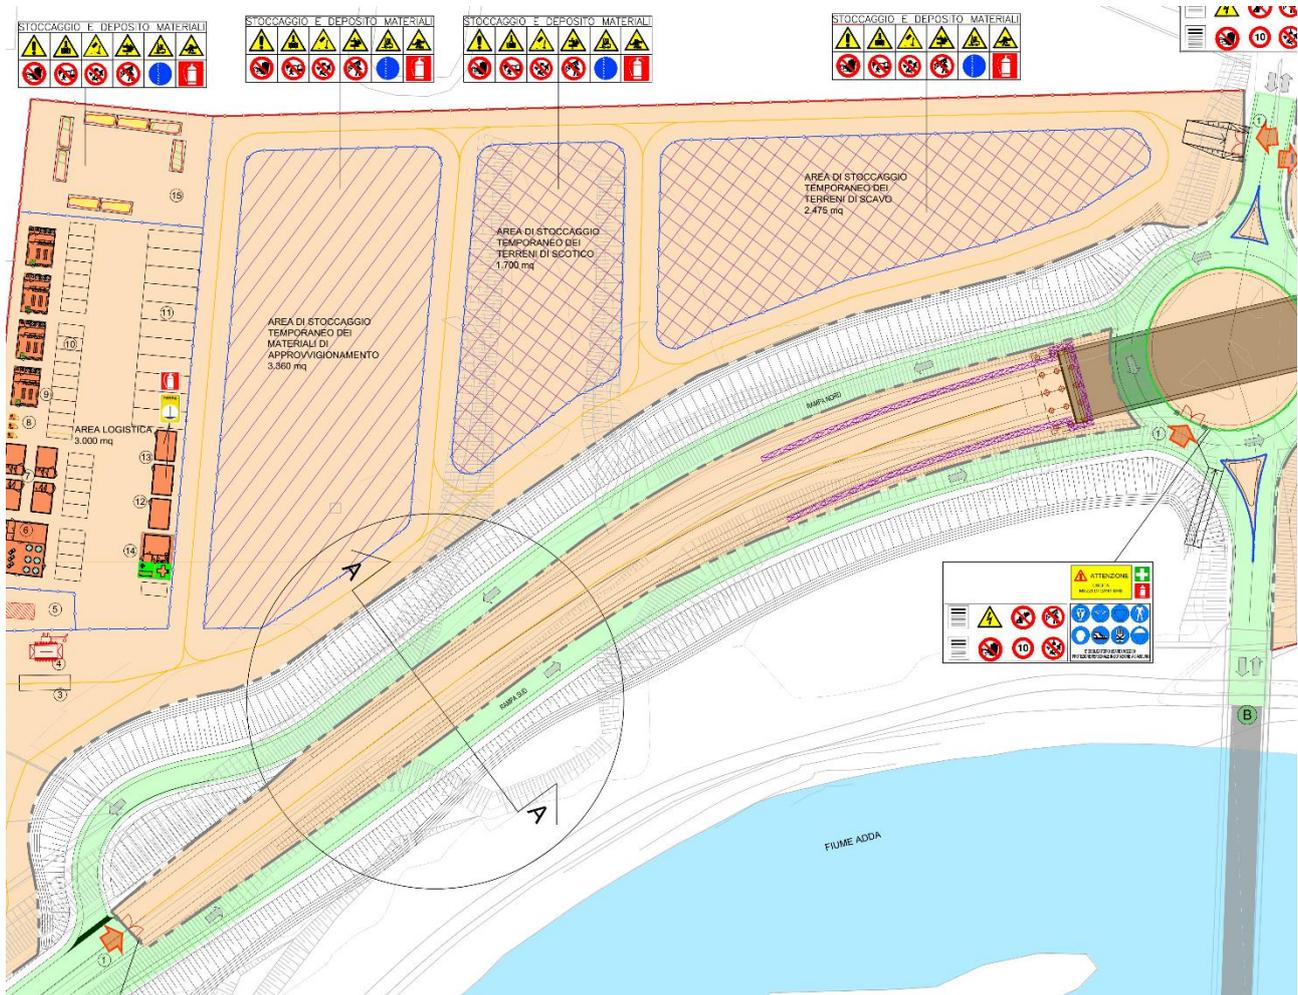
Realizzazione spalla A e muri di contenimento
